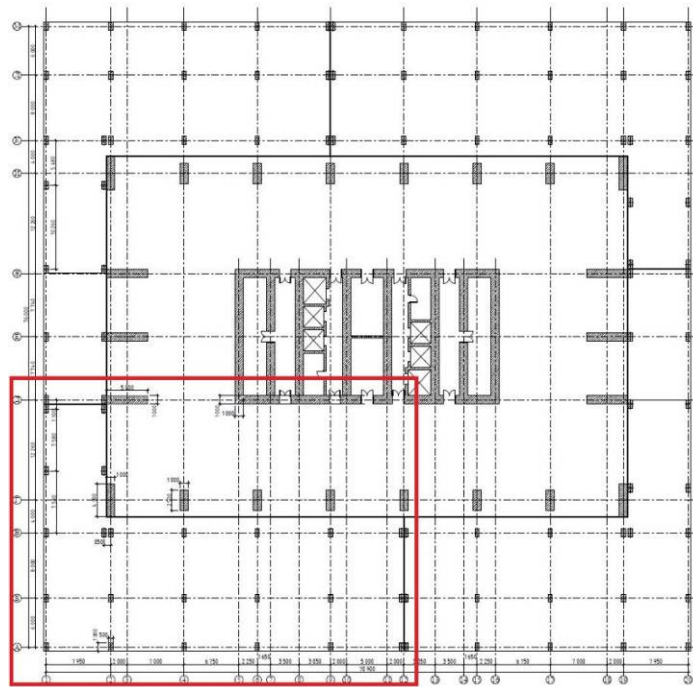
Архитектурный план несущих конструкций высотного здания на уровне -3 этажа. В выделенном фрагменте будет моделироваться локальное разрушение вертикальных несущих конструкций
